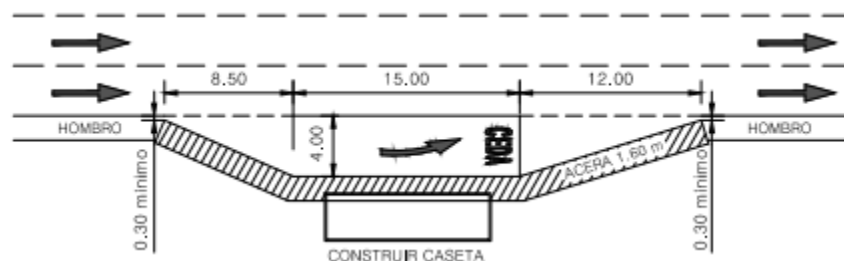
Dimensionamiento bahía puente peatonal San Sebastián
